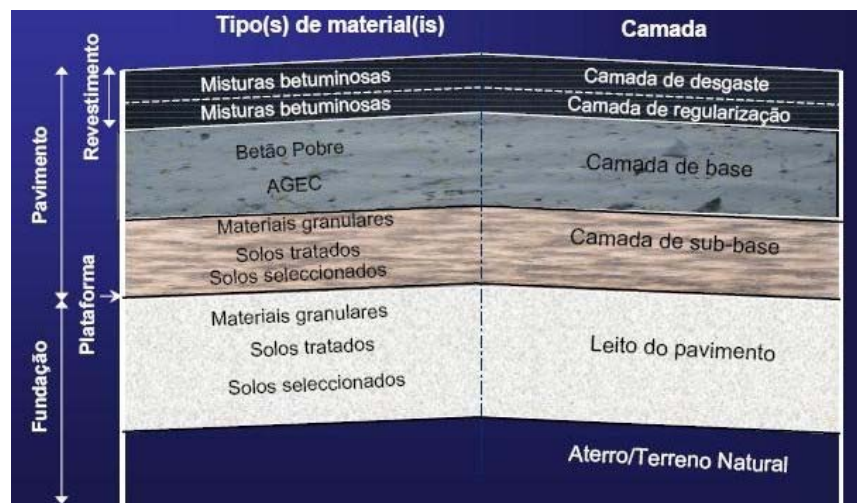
Constituição de um Pavimento Semi – rígido (LNEC, 2005)
